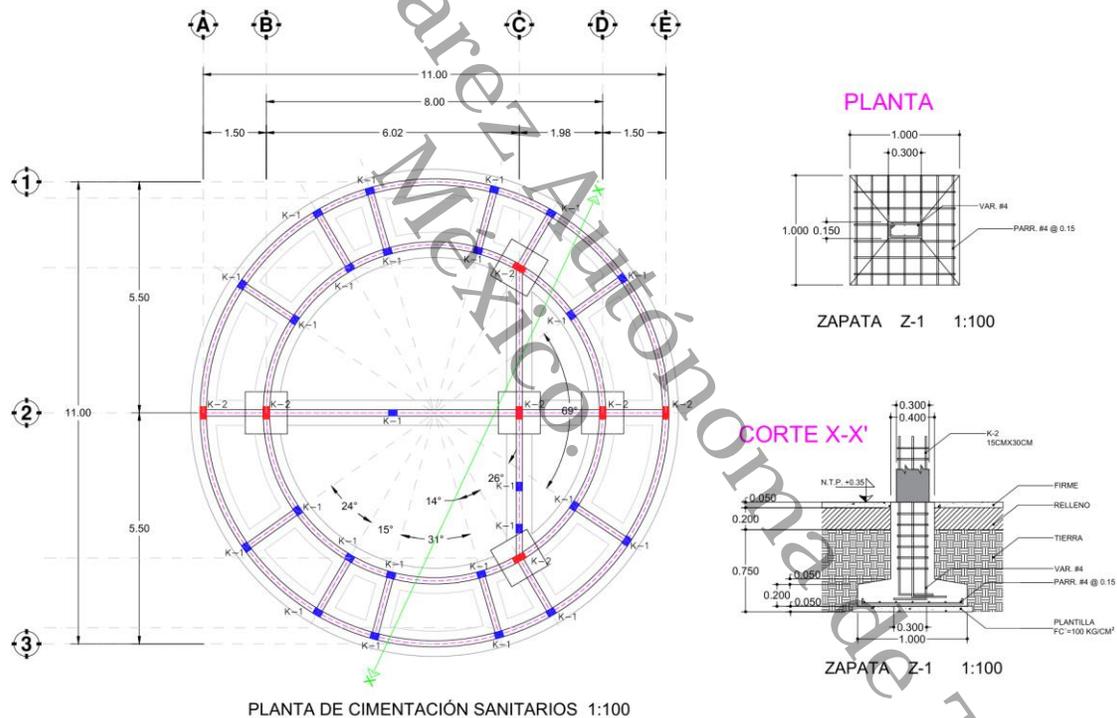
Planta y detalle de cimentación de los sanitarios. [Figura]. Fuente: Autores (2024).
